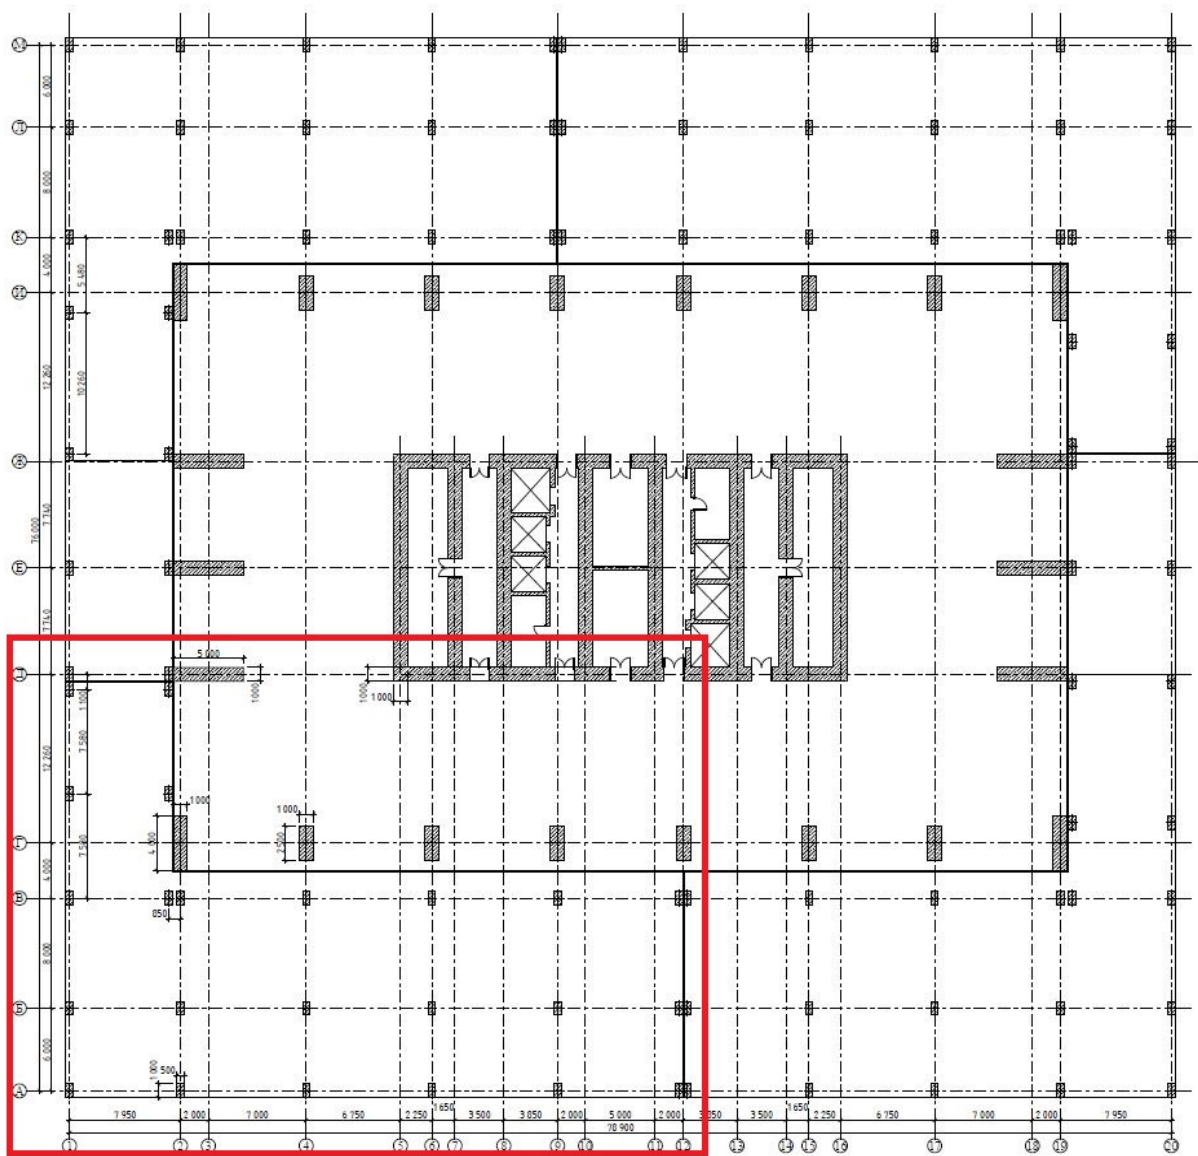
Архитектурный план несущих конструкций высотного здания на уровне 3 этажа. В выделенном фрагменте будет моделироваться локальное разрушение вертикальных несущих конструкций
